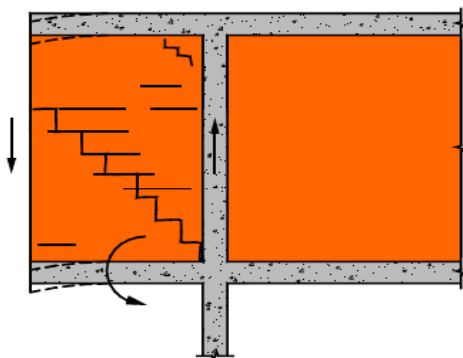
Fissuras em paredes de alvenaria provocadas pela deformação excessiva de lajes em consola [15]
